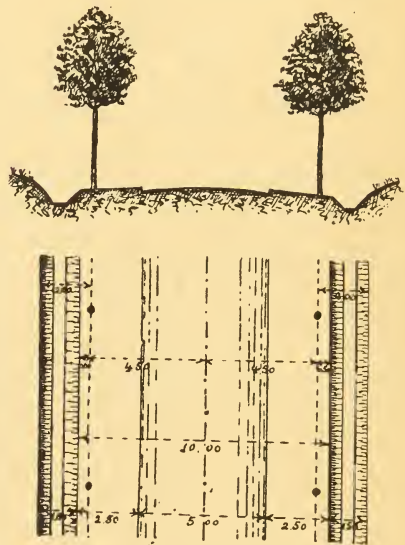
Plantations sur une route de 10 mètres de largeur.
